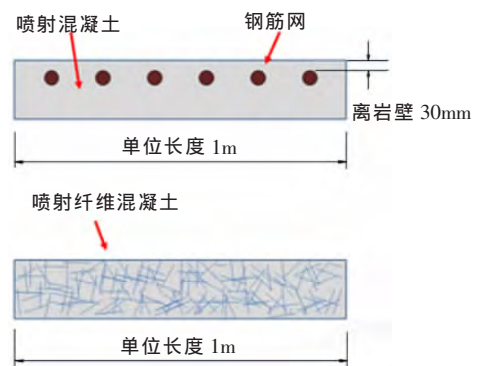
钢筋网增强喷射混凝土与纤维增强喷射混凝土结构的剖面示意图
